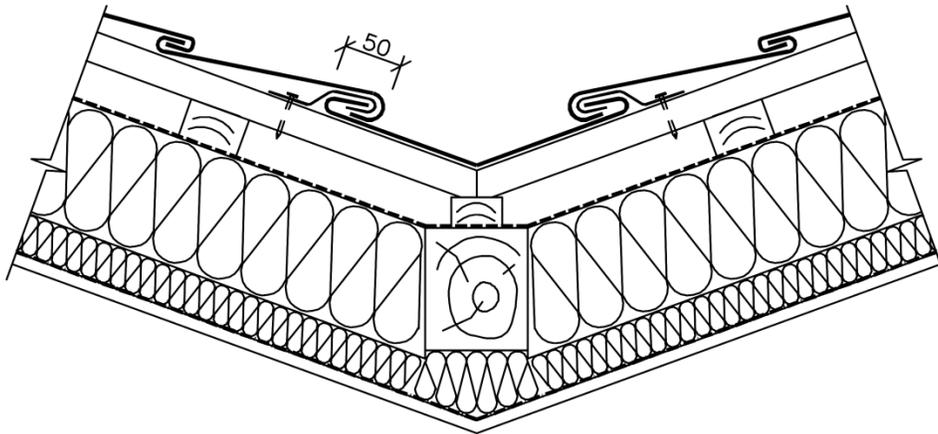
Nicht gelüfteter Dachfirst - Lösung des Dachfirstes mittels kleinen Firstkappen
